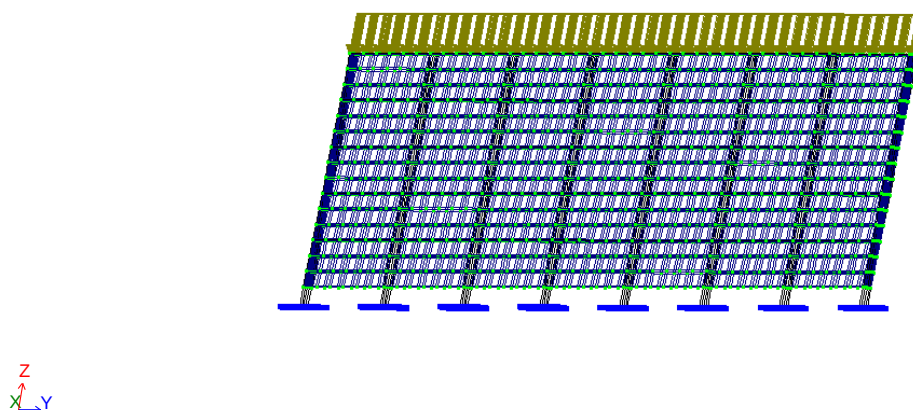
Схема снеговой нагрузки на покрытие здания
